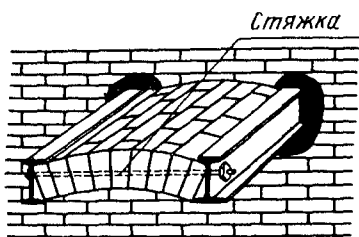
Основание под печь верхнего этажа в виде свода со стальной стяжкой
